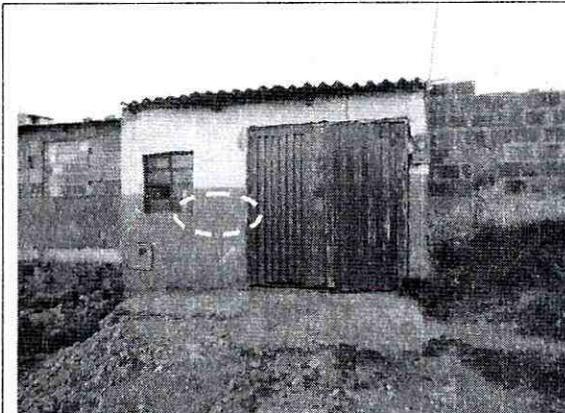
Vista de la fachada de la edificación emplazada en el predio con de la Carrera 18D Bis # 81A-35 Sur, Barrio El Tesorito de la Localidad de Ciudad Bolívar. Se presentan grietas en el muro de fachada.
